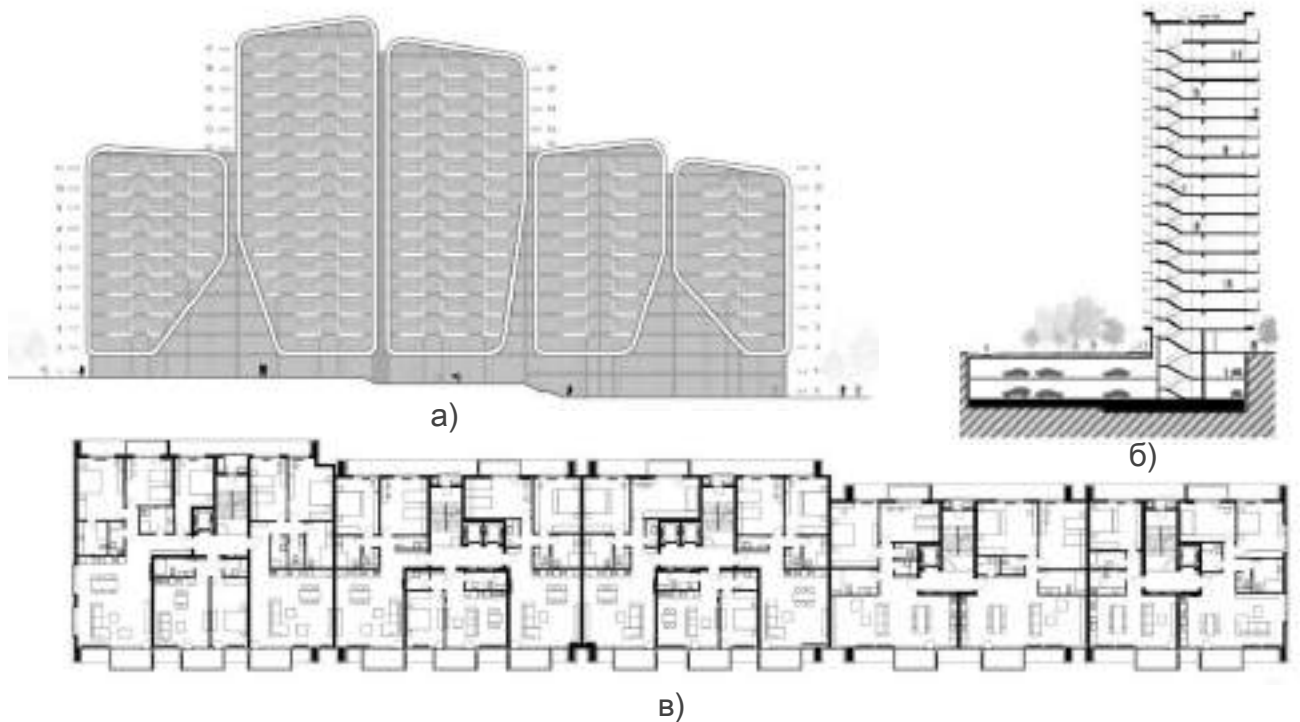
А3 – Advanced Architecture Apartments, м.Софія (Болгарія). *STARH* 2017 а. Фасад б. Розріз в. План типового поверху [38].
